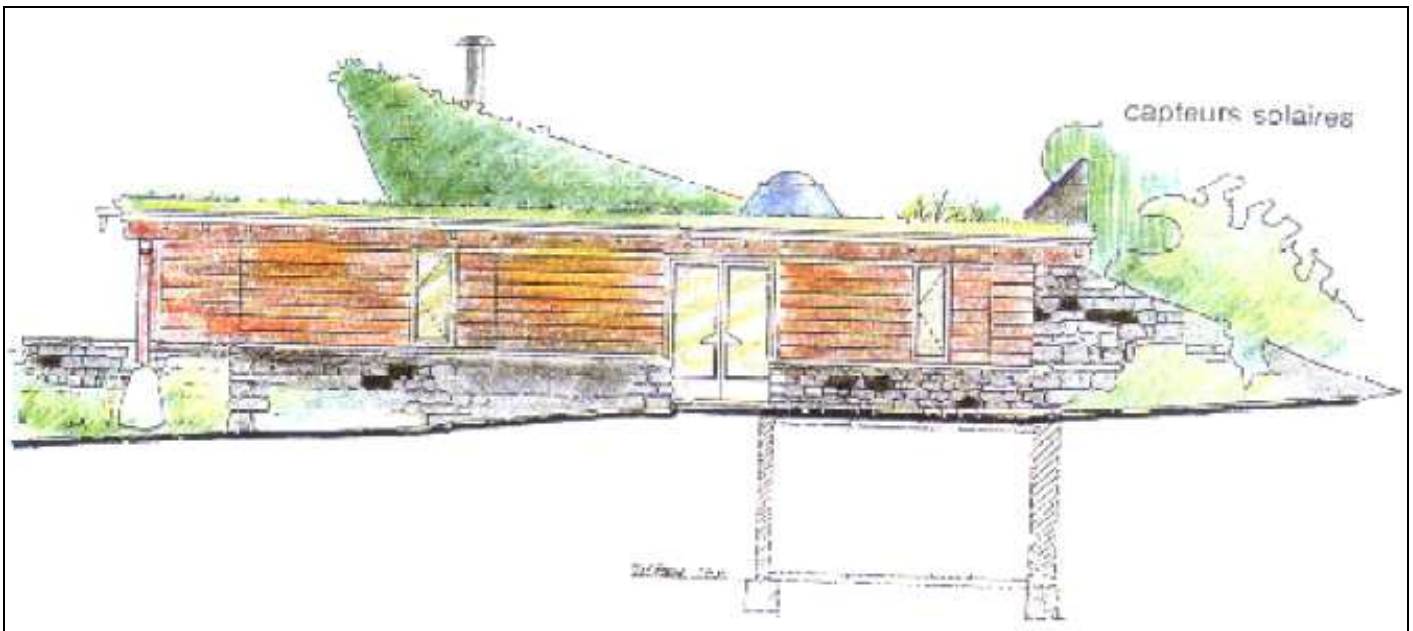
Maison Giraud-Ruet, vue projective, façade est.
